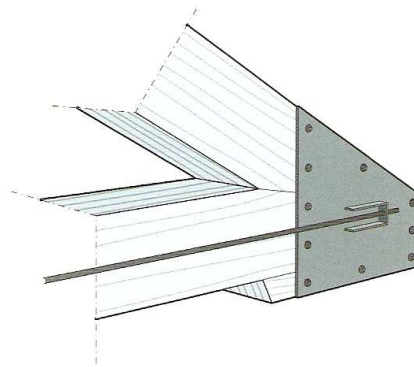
Aplicação de tirante e chapa metálica para reforço de ligação de perna com linha de asna
